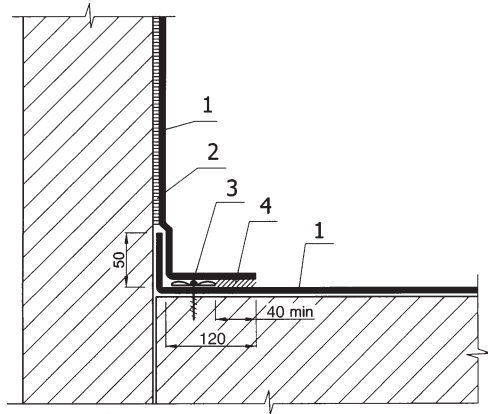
Примыкание кровли к парапету, стене (Вариант 2)
